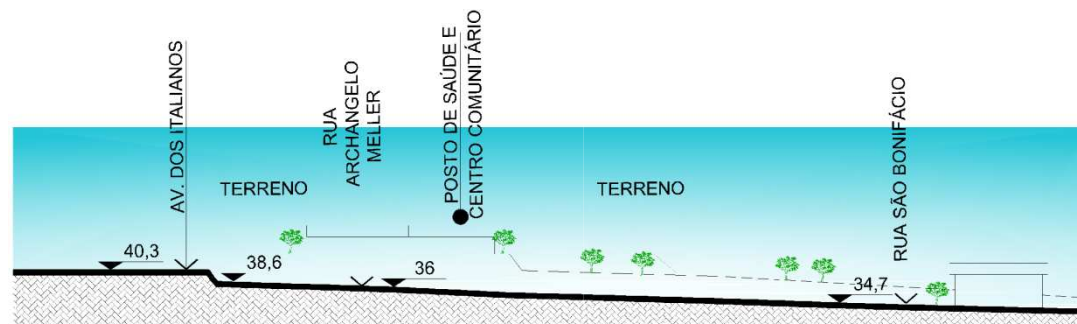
Corte Esquemático 01 – Perfil do terreno paralelo a Rua Nova Erexim
